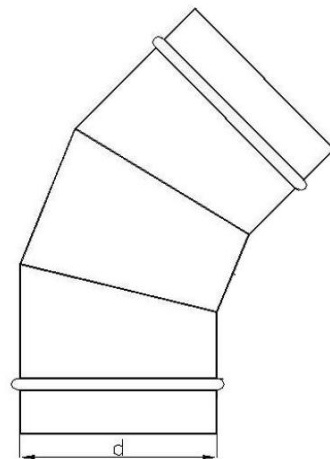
Відвід 60°, 45° сегментний круглого перерізу
